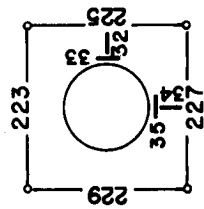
Betonstauchungen, Stahldehnungen P 3
